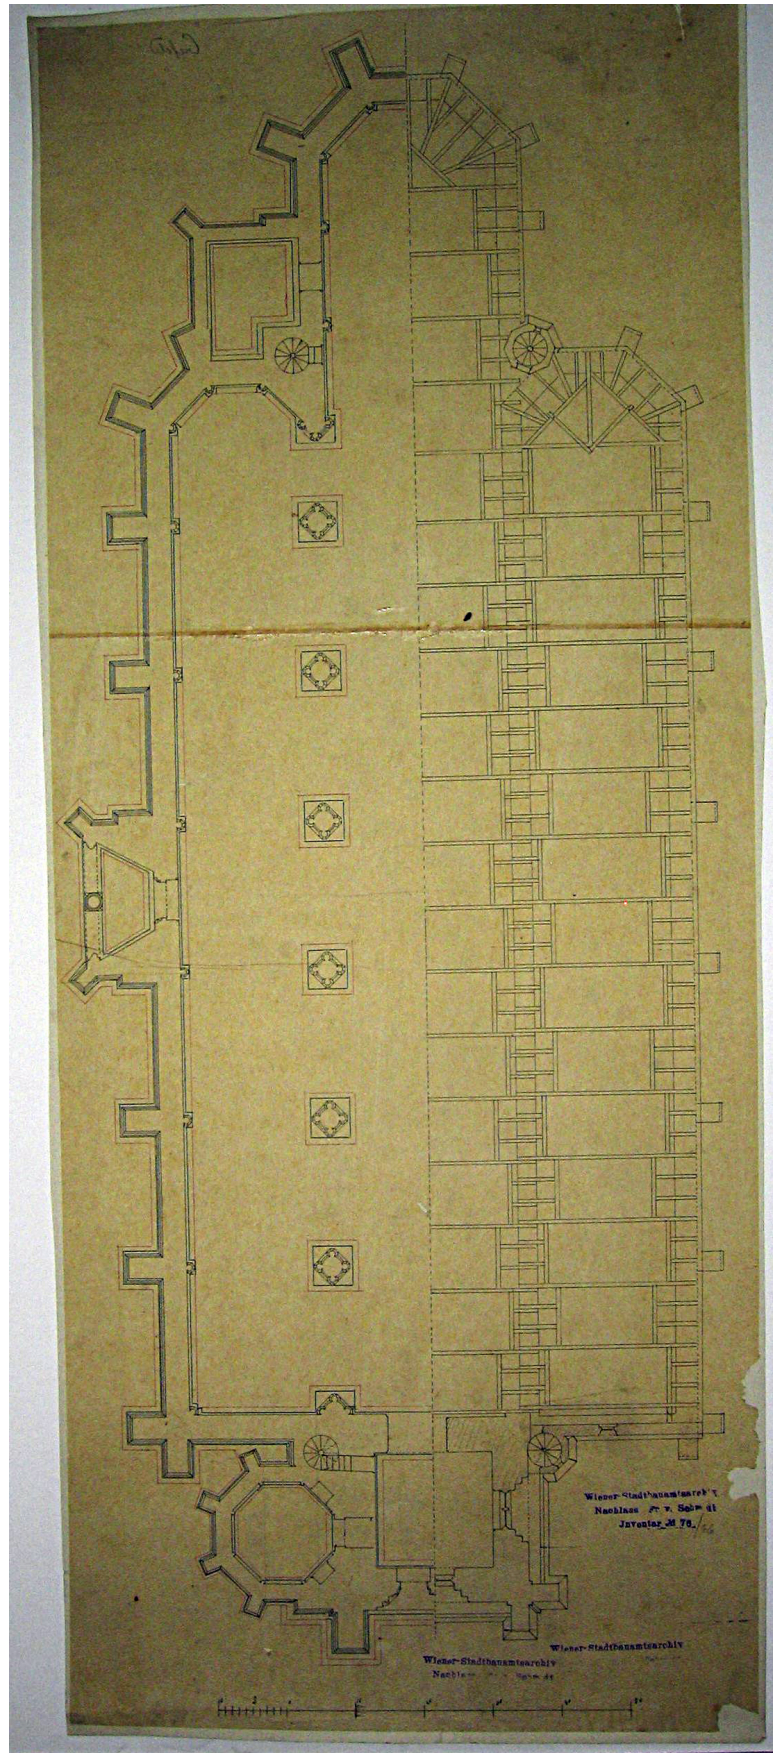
WM, Inv.-Nr. 157.76/56 der Ausführung nahe, Grundriss
